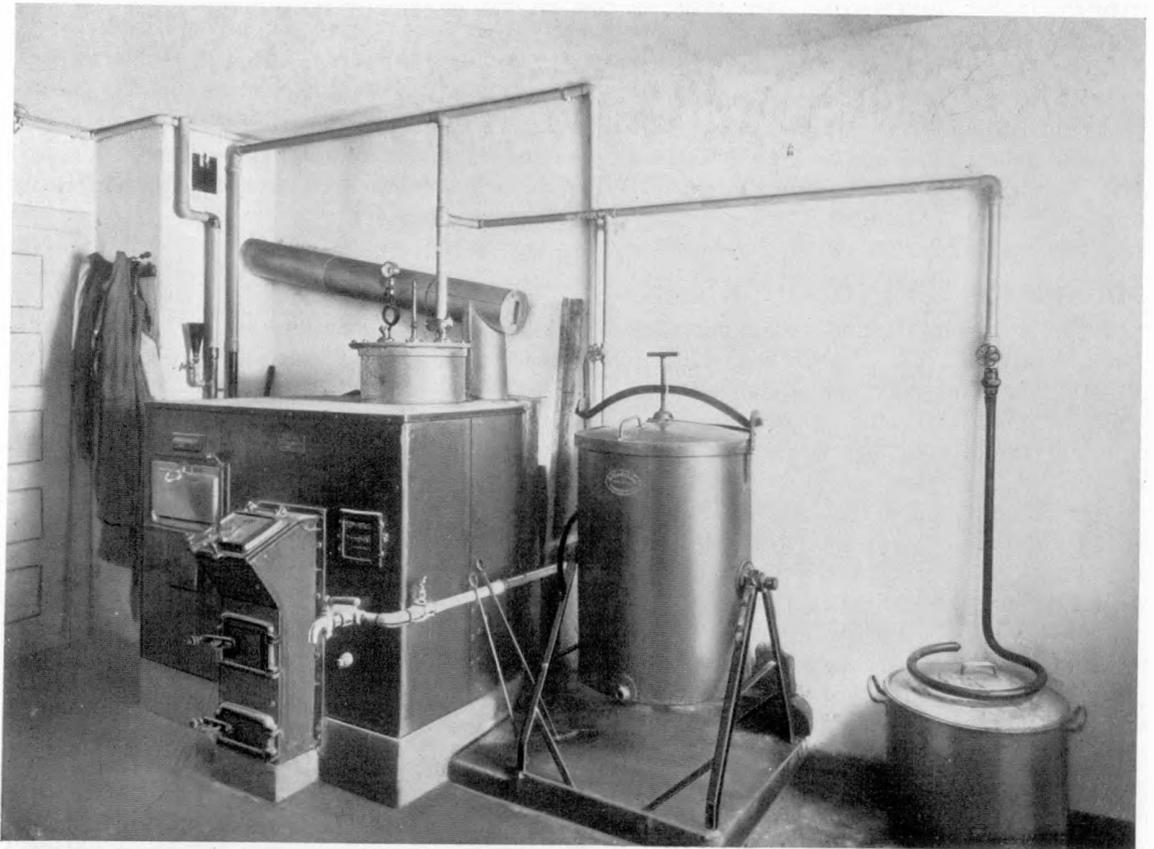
Dampferzeuger und Kartoffelfaß bei Typ IV. Rechts kupferne Heizschlange zum Wäschekochen, im Dampferzeuger links neben der Feuerung eingebaute Kochplatte.
